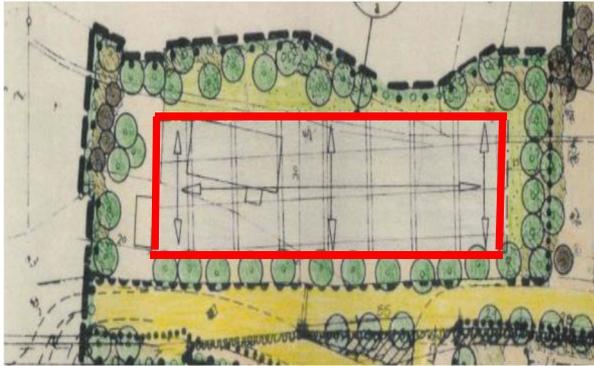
Das Plangebiet im bisherigen Bebauungsplan
